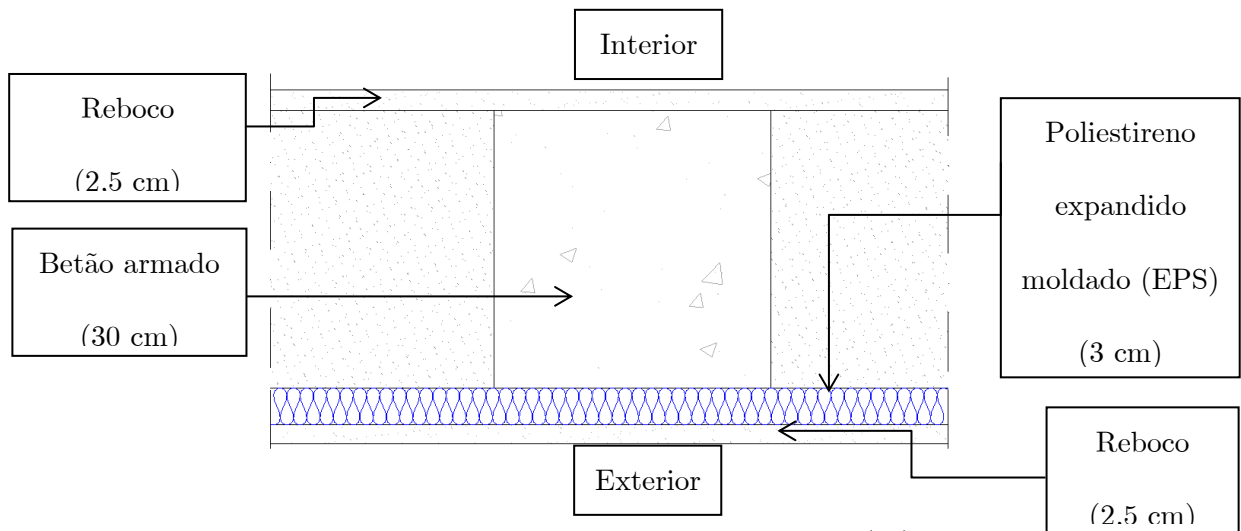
Pormenor construtivo dos pilares (N<sub>2</sub>)
